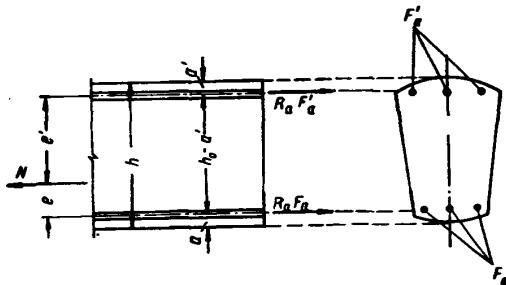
Схема расположения усилий в поперечном сечении растянутого с малым эксцентрикитетом железобетонного элемента при расчете его на прочность
